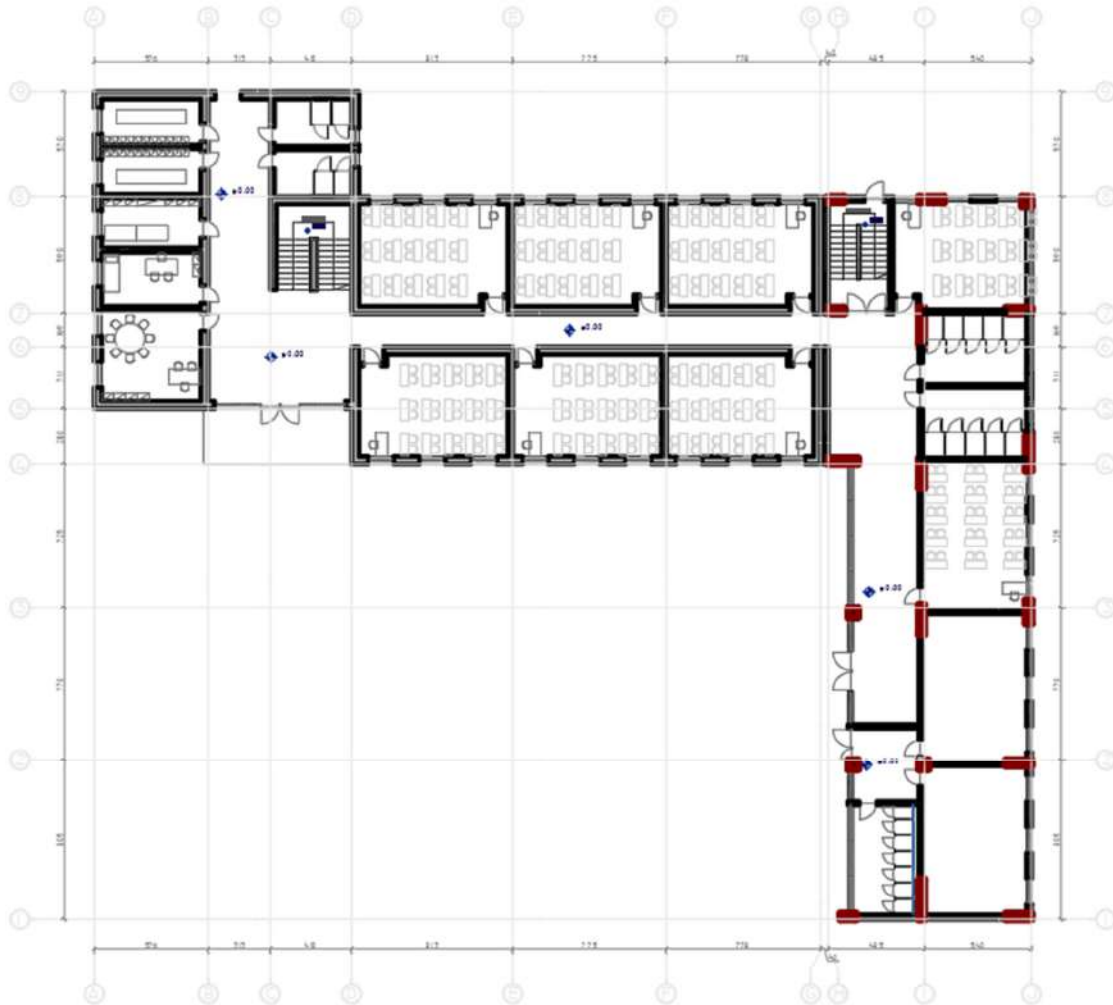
Planimetria e katit përdhe të ndërtesës
